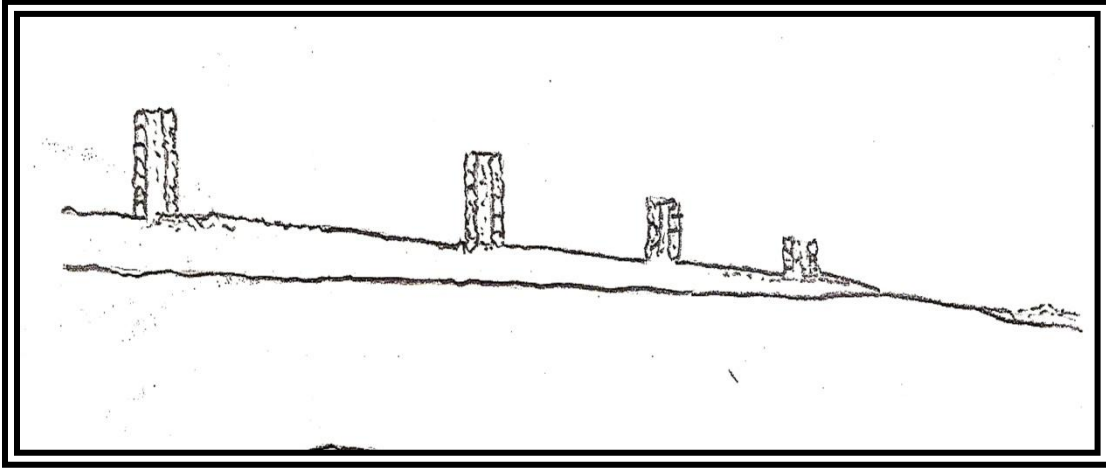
مسقط أفقي لإحدى خزرات عين الوزيرية
